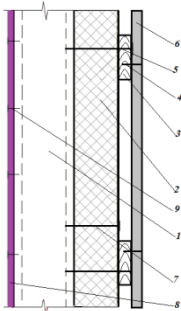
Система внутреннего утепления каркасной металлоконструкции: 1 – несущая стена (металлокаркас); 2 – теплоизоляция (рулонный несшитый полиэтилен); 3 – деревянный брусок - контррейка; 4 – крепление облицовки; 5 – крепление бруска; 6 – облицовка; 7 – крепление утеплителя на металлокаркасе; 8 – фасадная облицовка; 9 – крепеж фасадной облицовки
